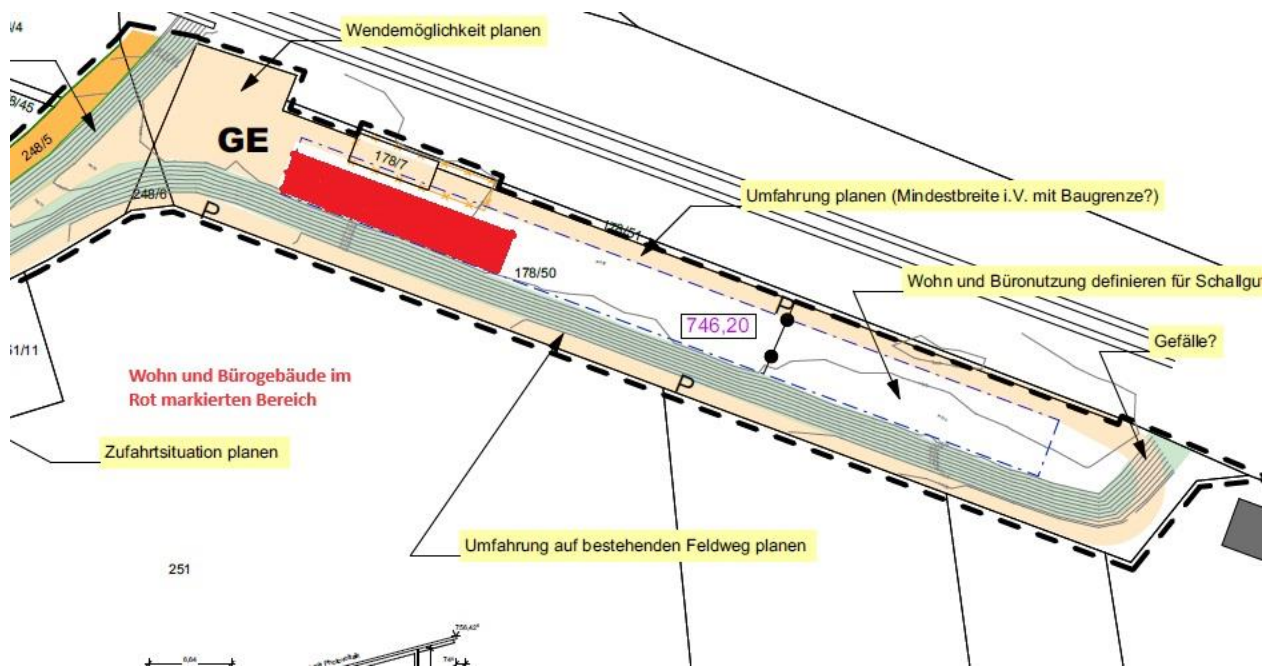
Vorentwurf des Bebauungsplans, Lageplan, übersandt am 10.07.2024
